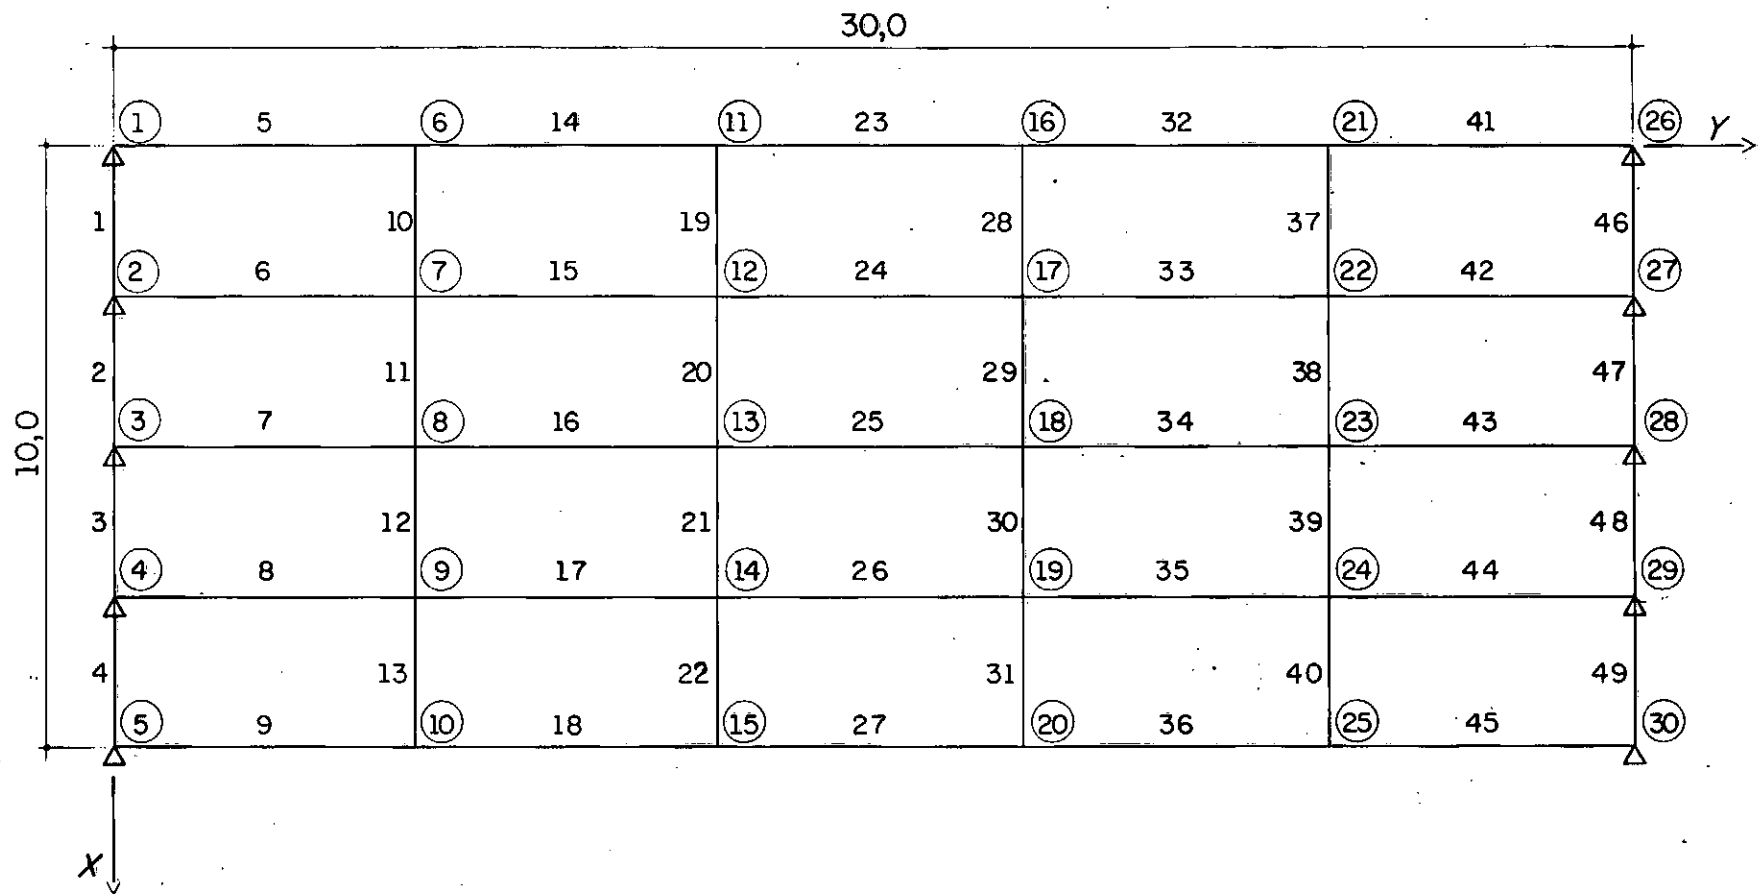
SISTEMA ESTRUTURAL DA GRELHA RETA (EXEMPLO 1)
